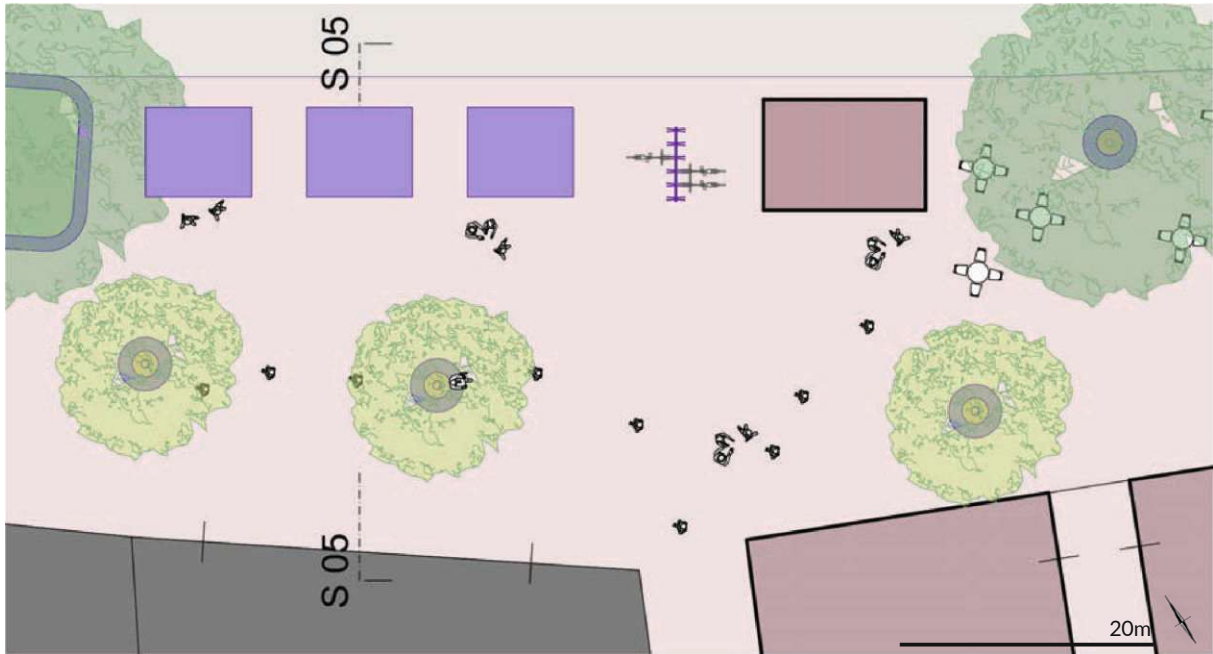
Grundrissausschnitt Marktplatz, eigene Darstellung
